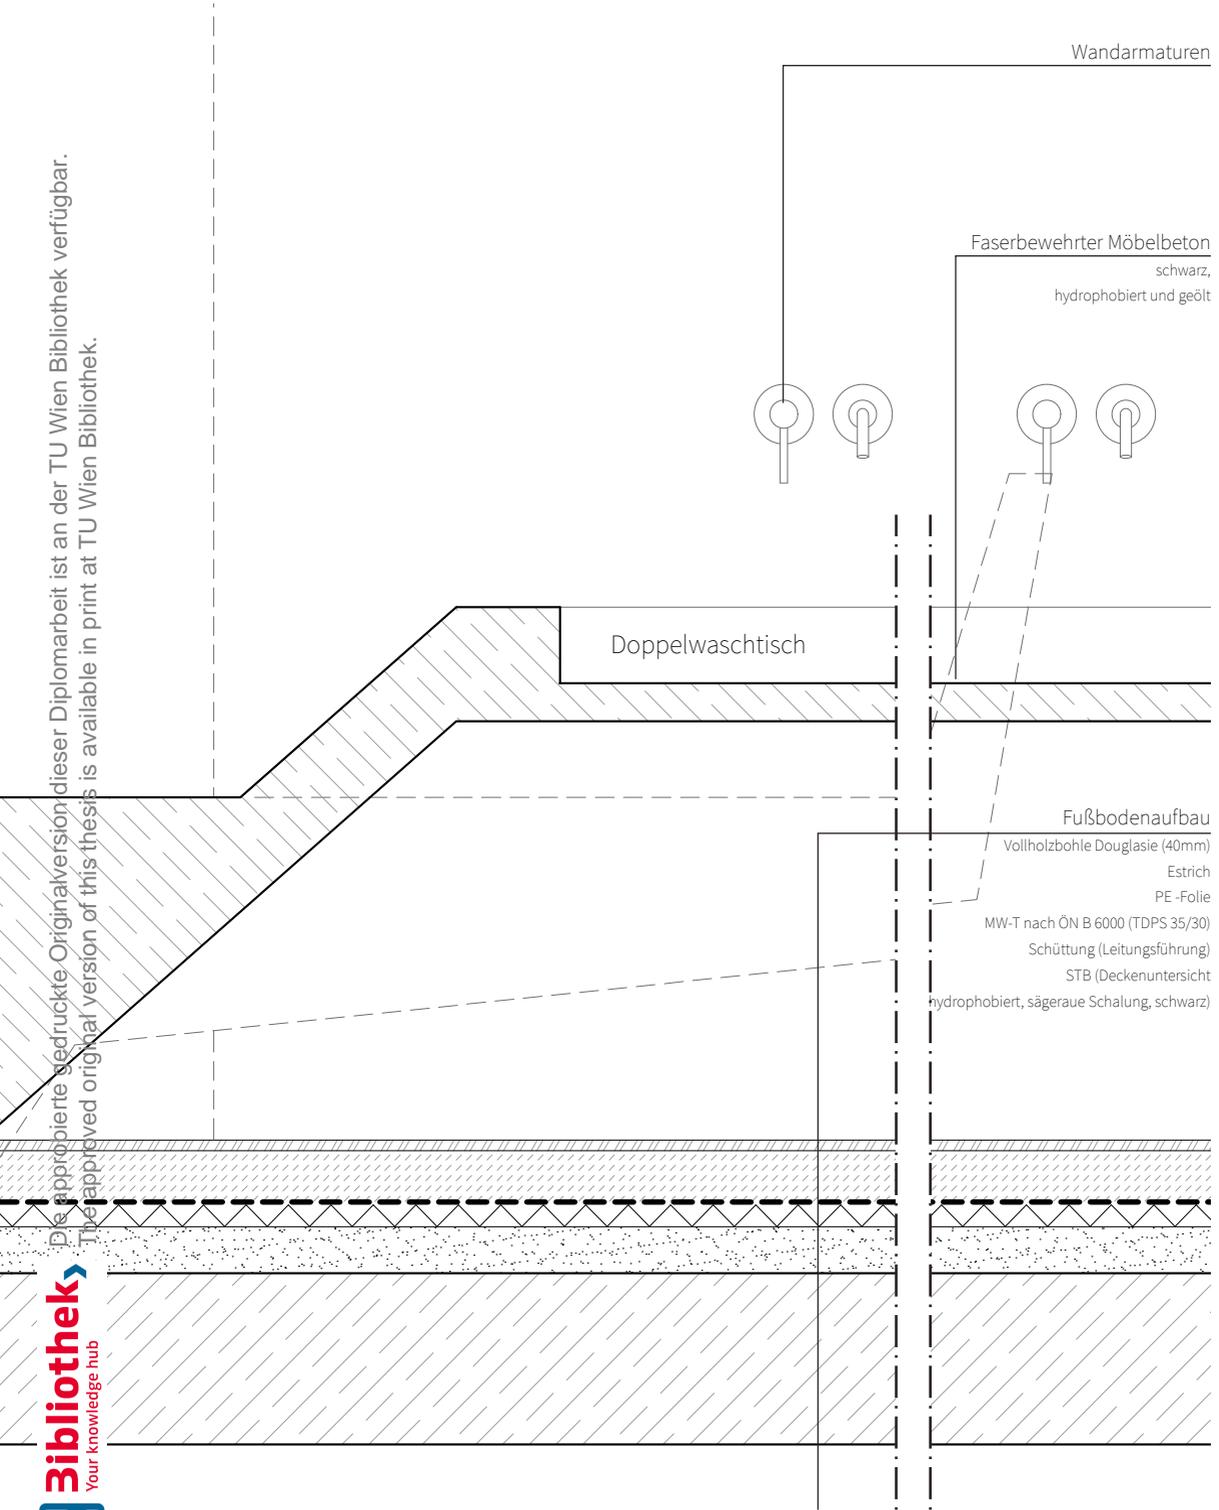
| Möblierung Hotelzimmer Junior - Suite Detailschnitt 4 | Wanne und Waschtisch aus Möbelbeton
